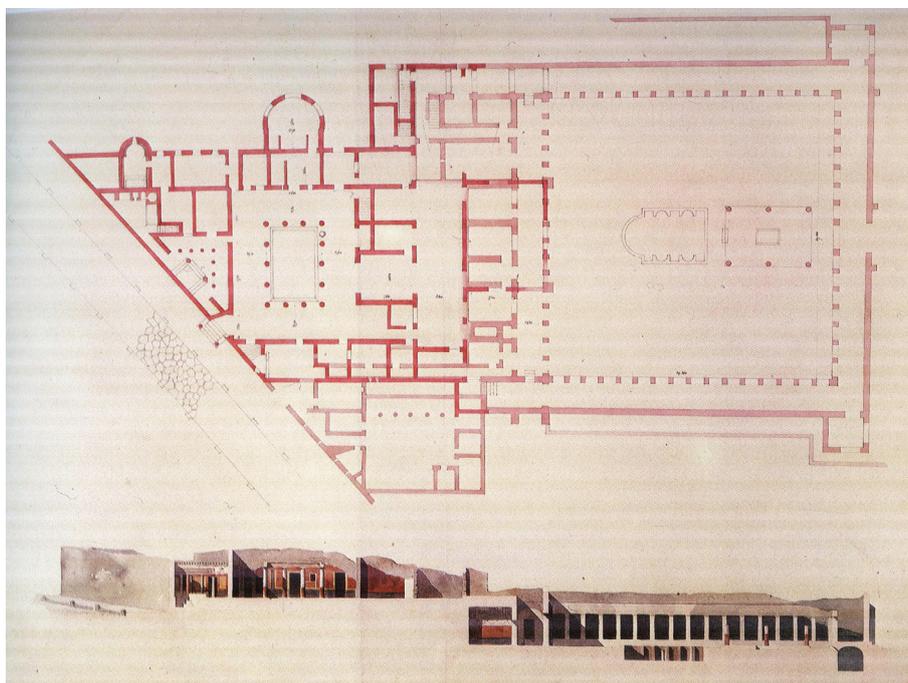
F. Duban, Plan et coupe de la Maison de Diomède, 1823-28.
